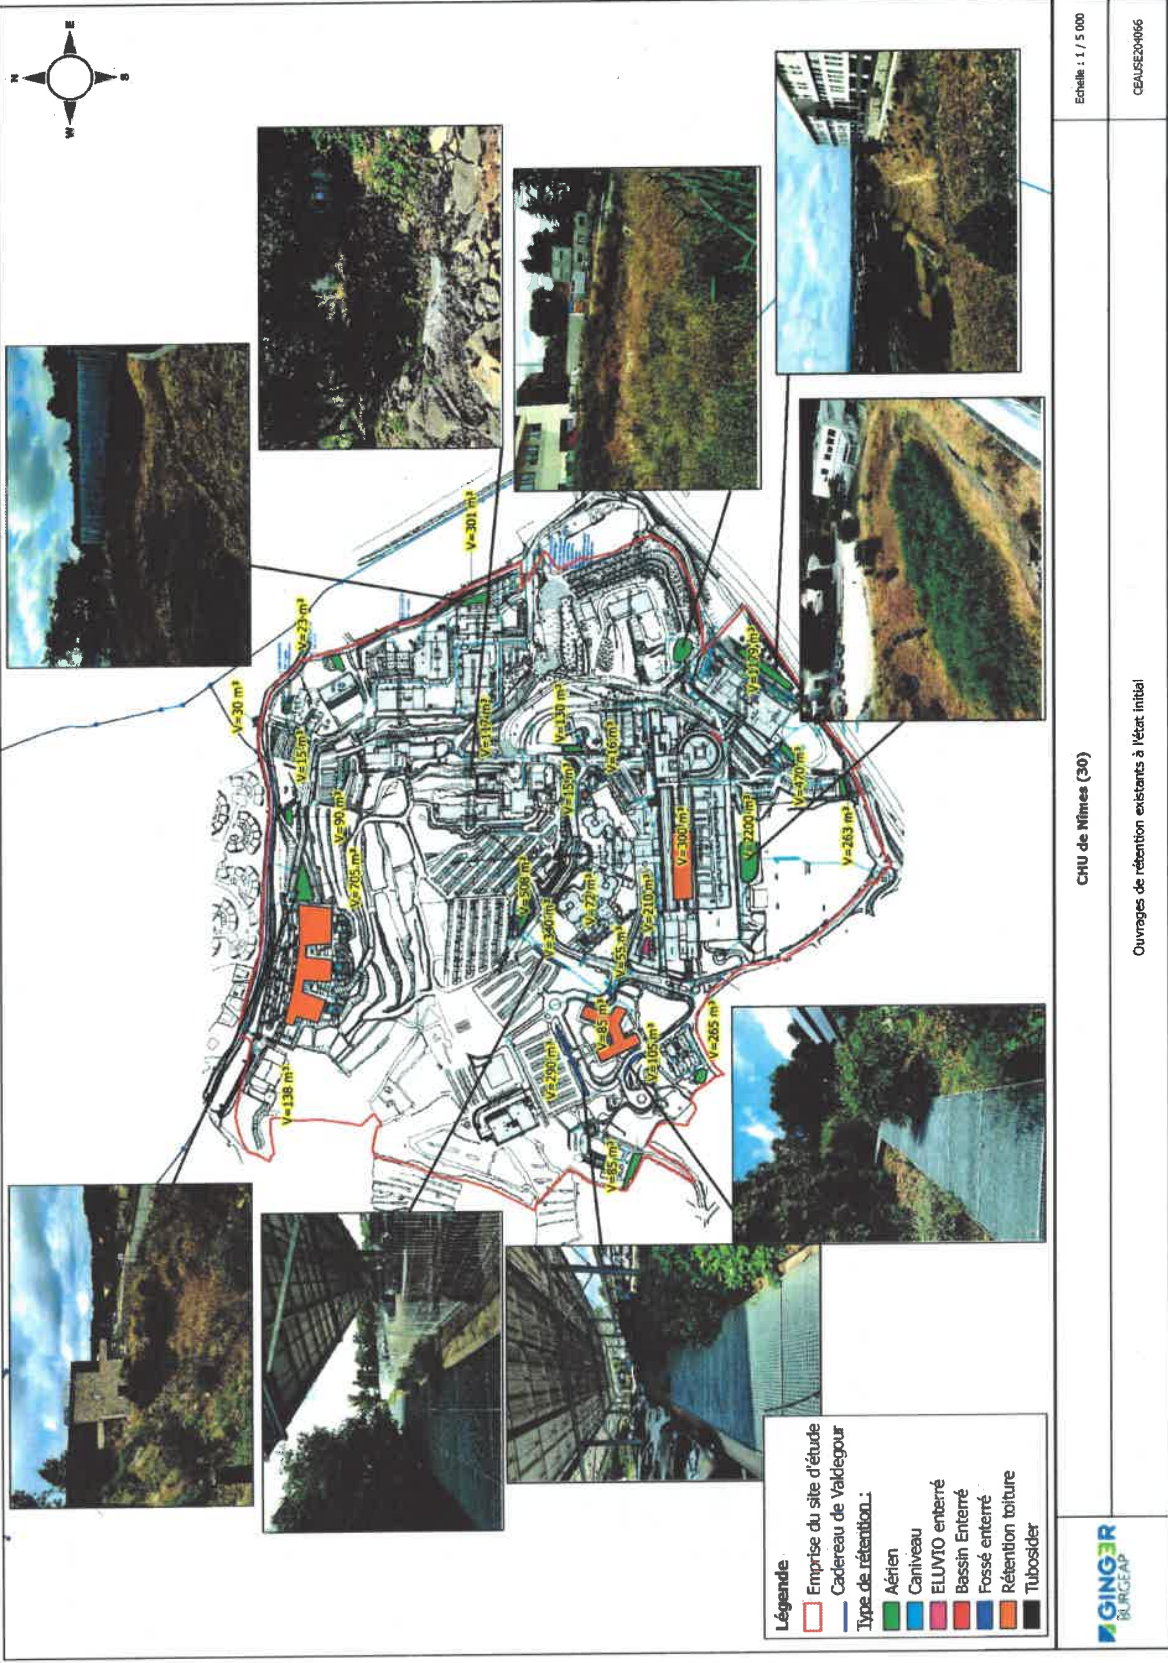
Localisation des ouvrages existants à l'état initial (source : BURGEAP sur plan de masse du CHU)
